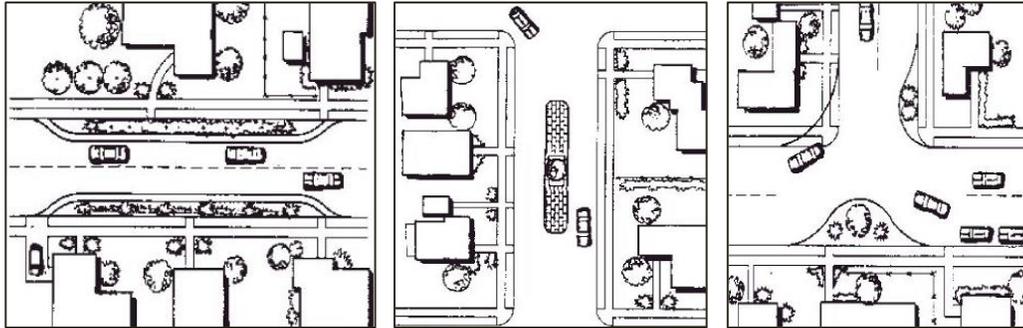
Estrechamientos, isletas separadoras y modificación de intersección en T
